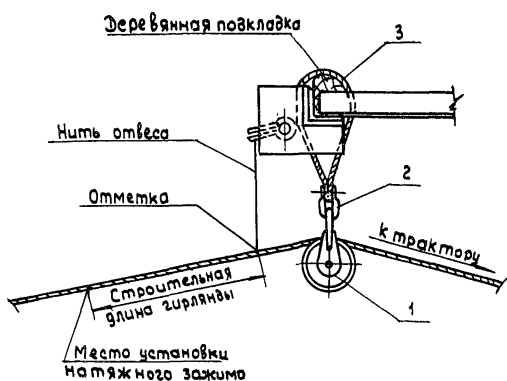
Узел „Я“ Нанесение отметки на проводе при визировании в анкерном пролете.
